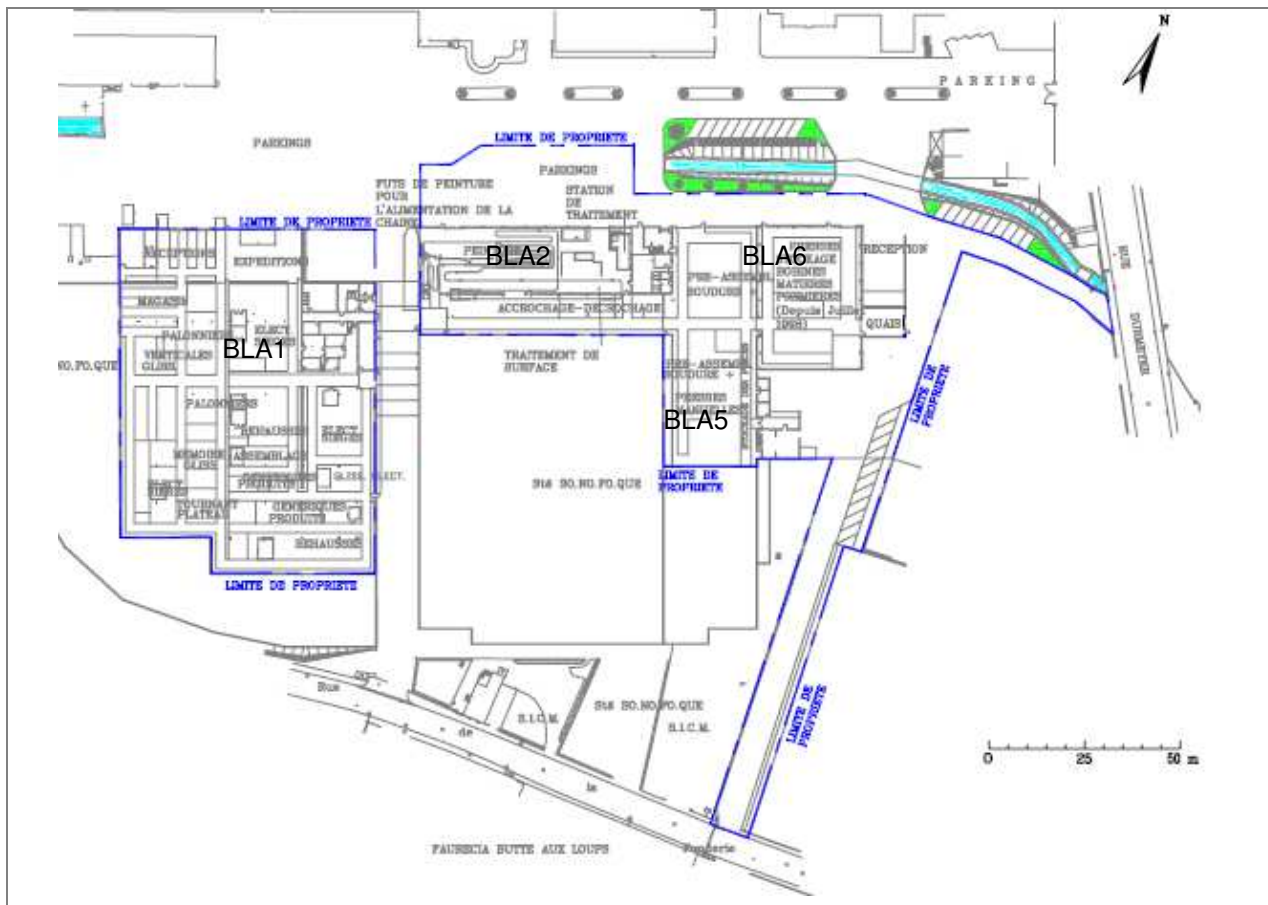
Localisation géographique et plan du site site (source : Géoportail et plan FAURECIA)
